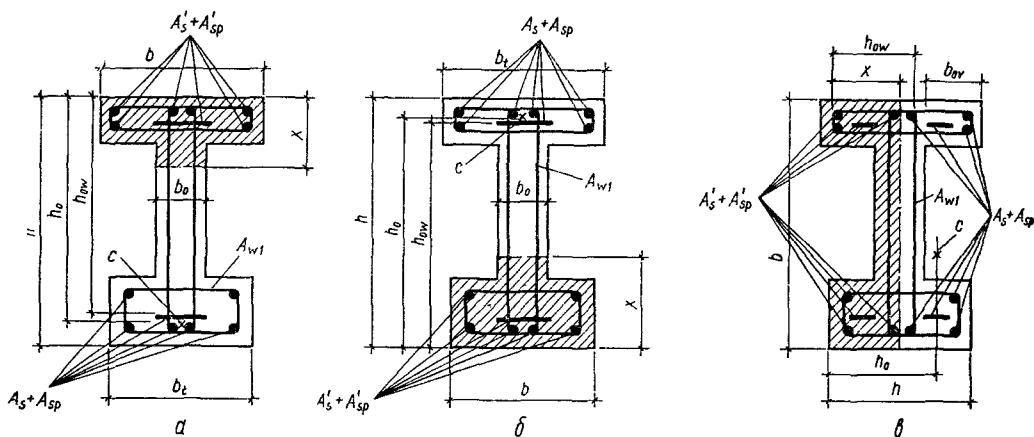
Схемы расположения сжатой зоны в пространственном сечении железобетонного элемента двутаврового сечения, работающего на кручение с изгибом:
